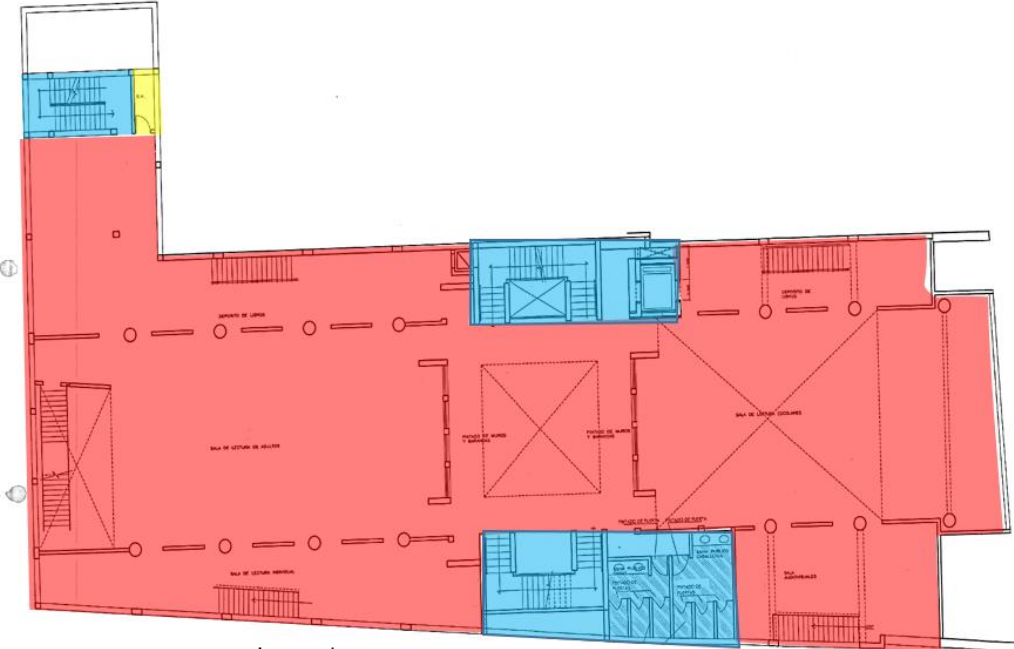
Segunda Planta del Centro Cultural Ricardo Palma
